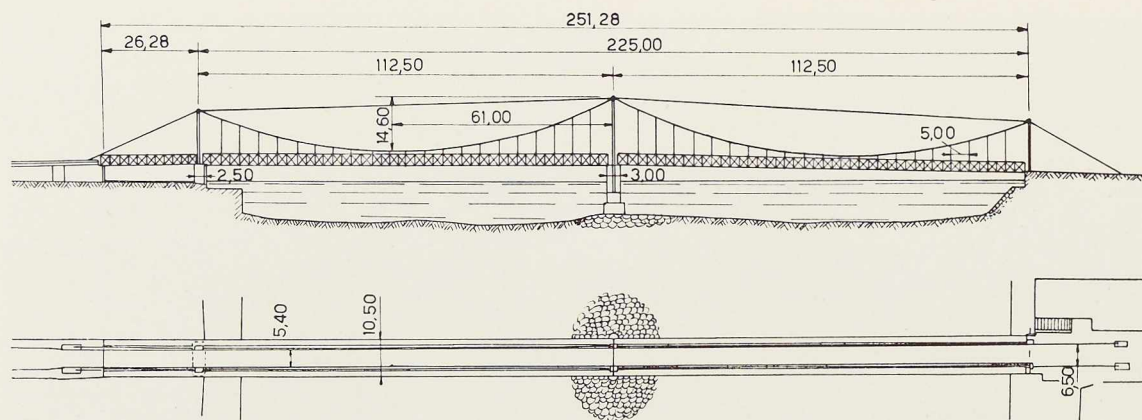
Elévation et plan du nouveau pont suspendu de Valence.
